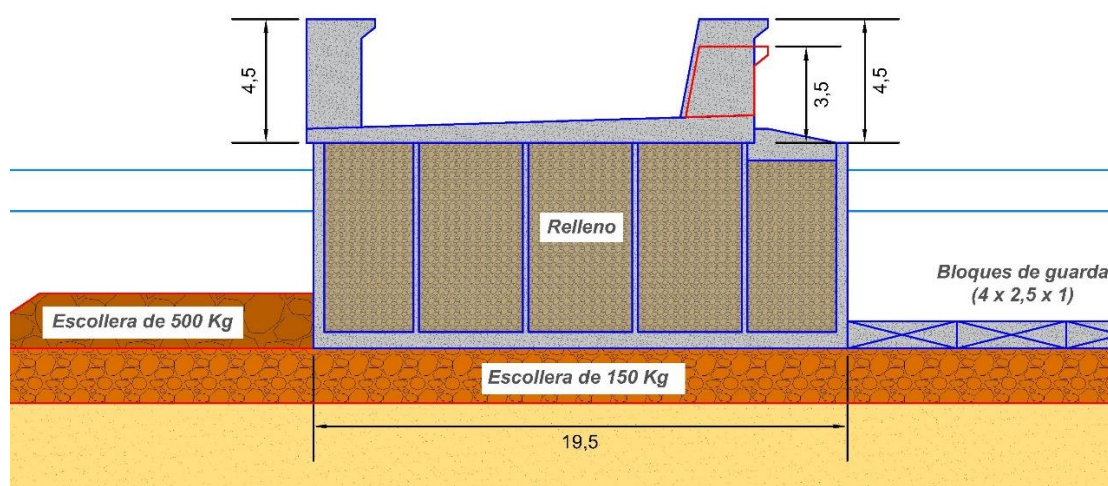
Sección tipo de la Alternativa B. Cotas en metros.
